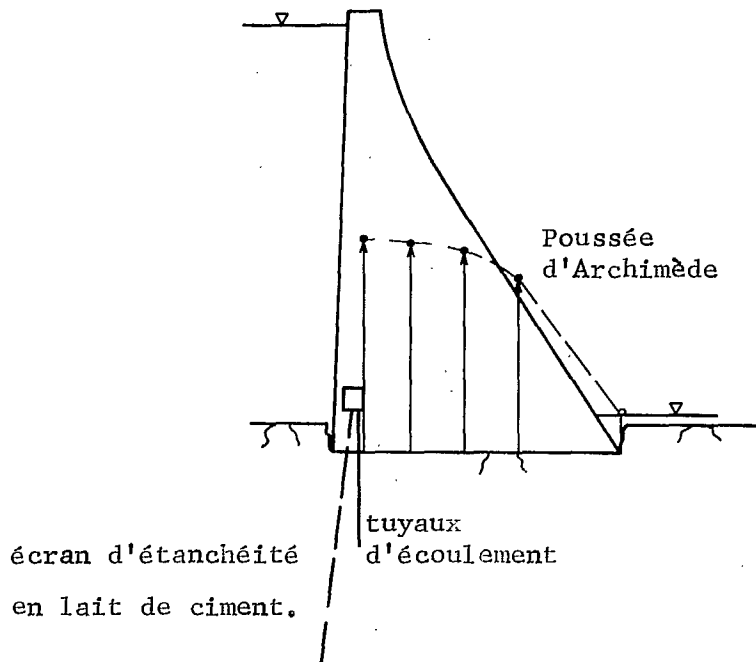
Diagramme typique de la poussée d'Archimède à la base d'un barrage.
